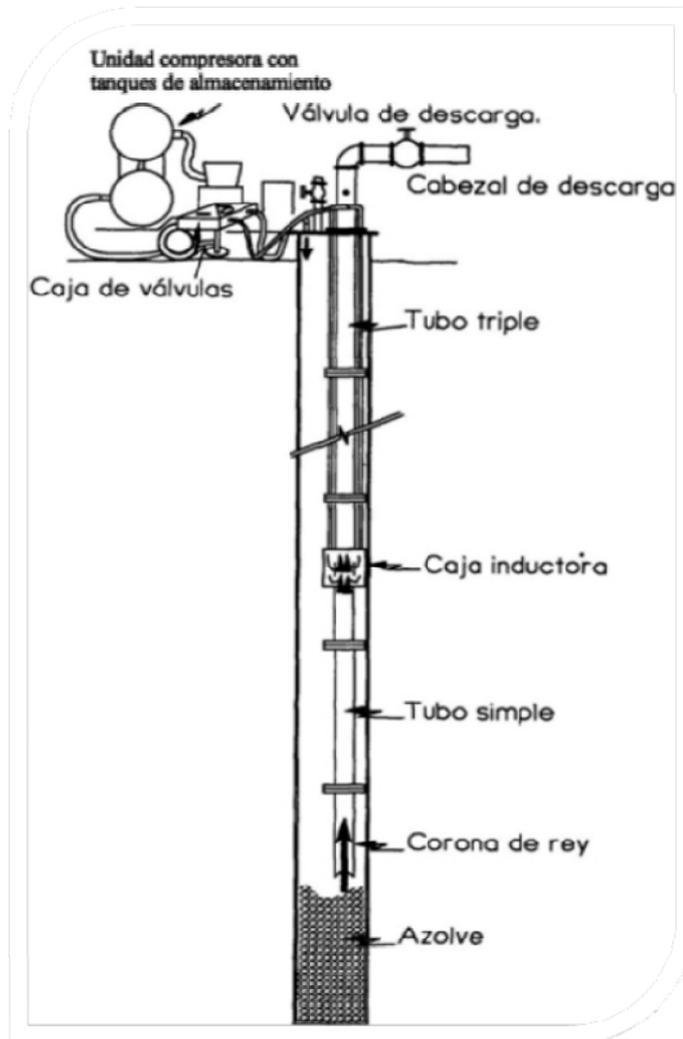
Dispositivo para desarrollo neumático a pozo cerrado.
